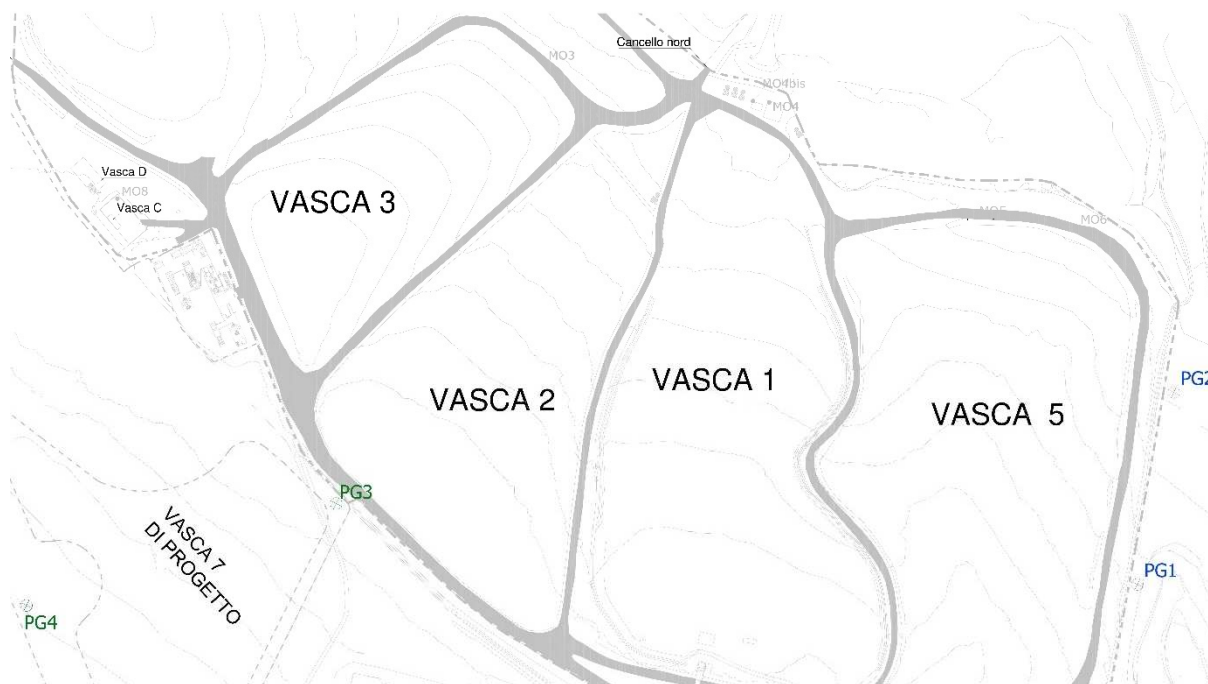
Stralcio planimetrico dei punti di monitoraggio fughe di gas dal suolo
